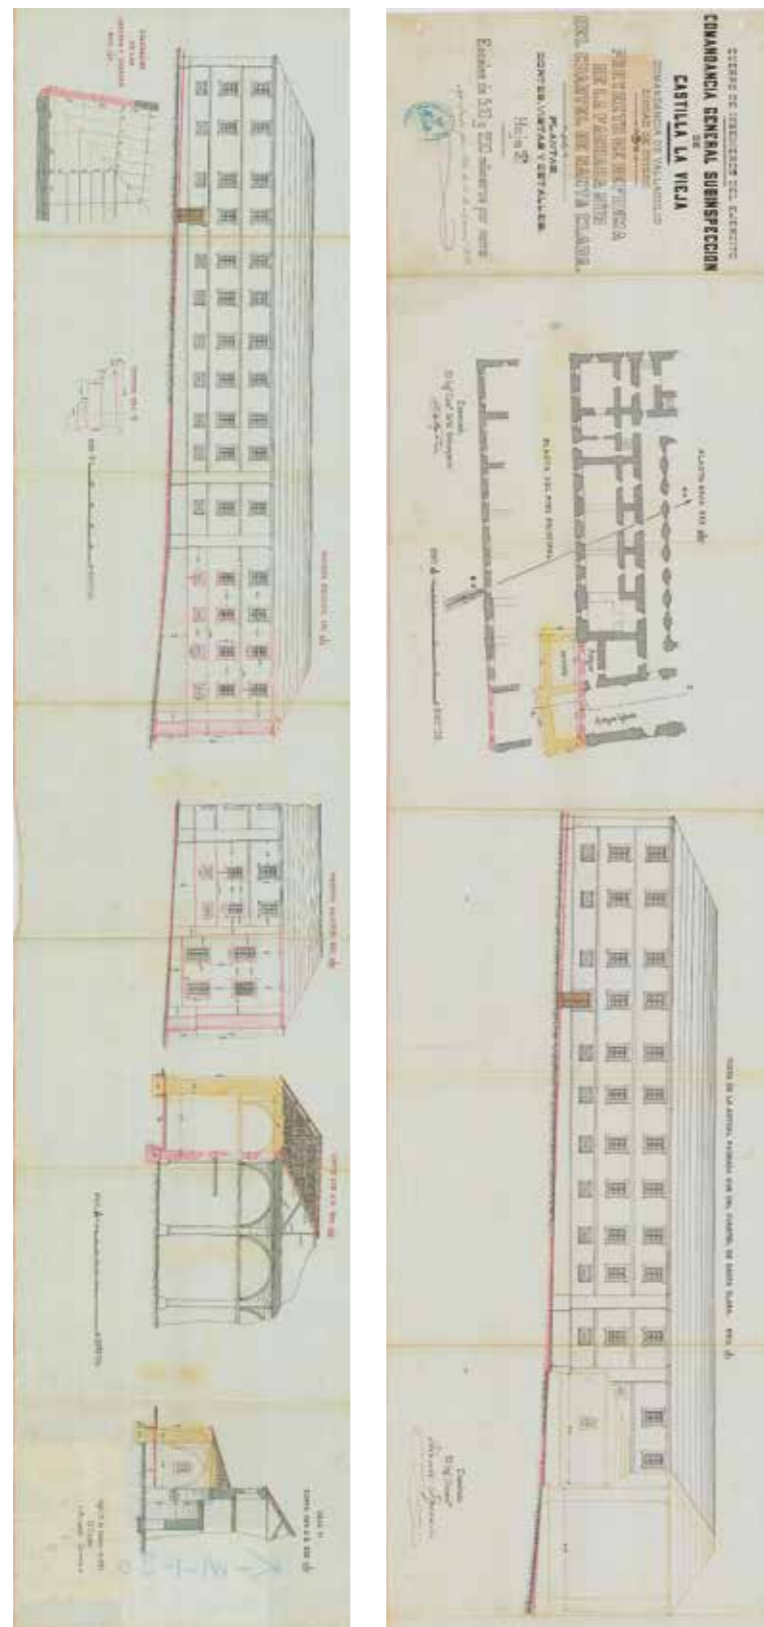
Plano, alzados y secciones del proyecto de reforma de la fachada este del convento en 1886 (AGNM, 0-03-09).
